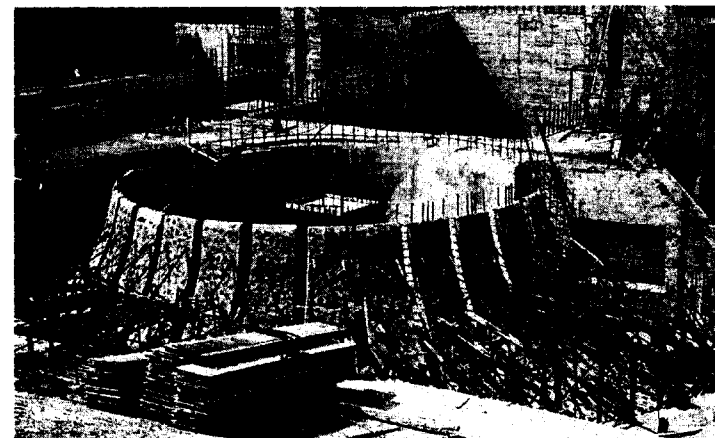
Опалубка из железобетонных скорлуп на конусе отсасывающей трубы Рижской ГЭС
